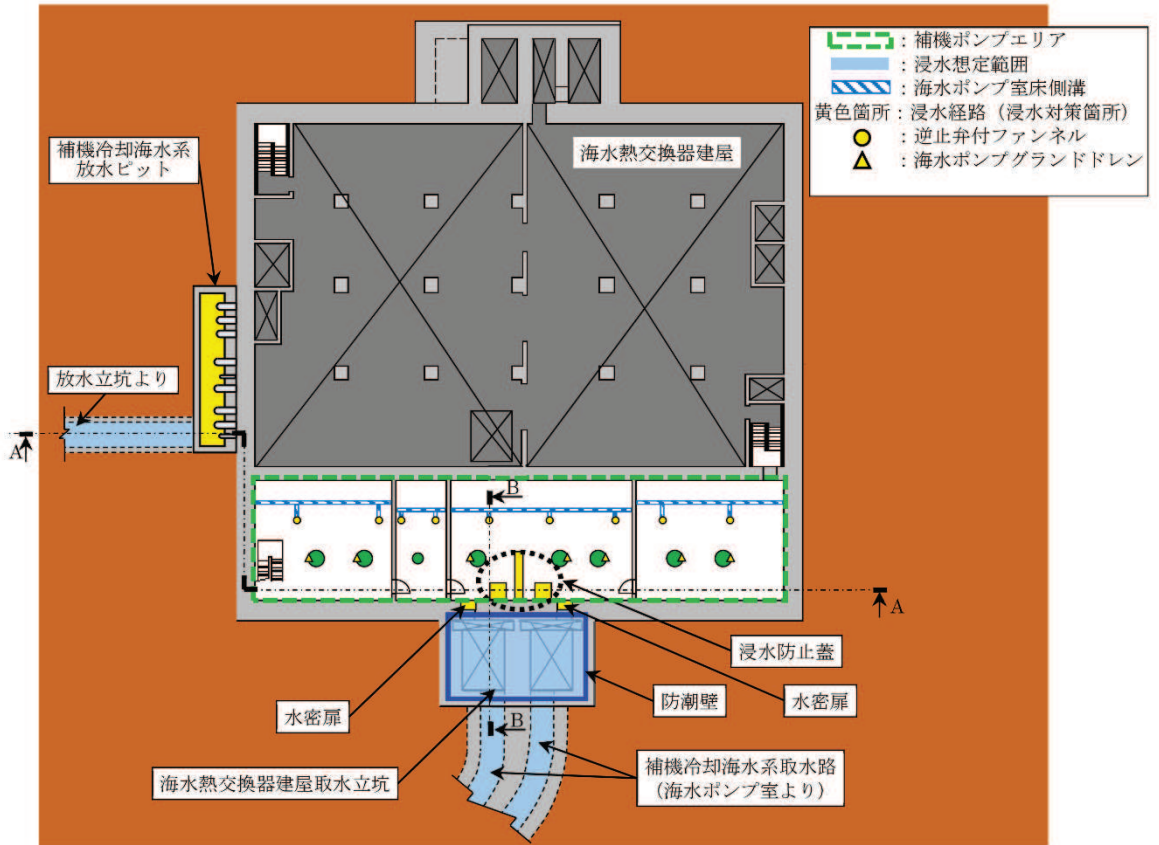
3号機 海水熱交換器建屋 浸水対策配置図 (平面図)
